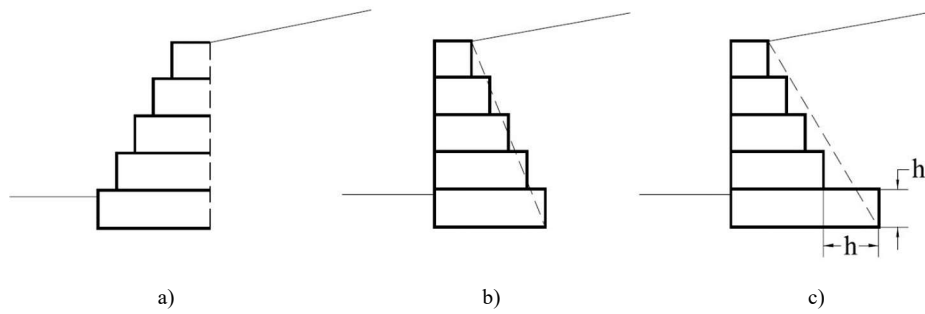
Plano de aplicação do empuxo ativo; a) plano vertical; b) plano inclinado; c) plano inclinado restringido (BARROS, 2010).
